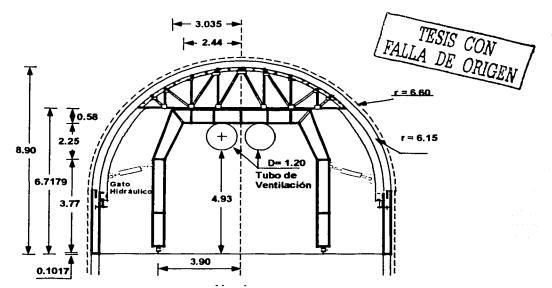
Croquis de la cimbra para el colado en la clave del túnel.
